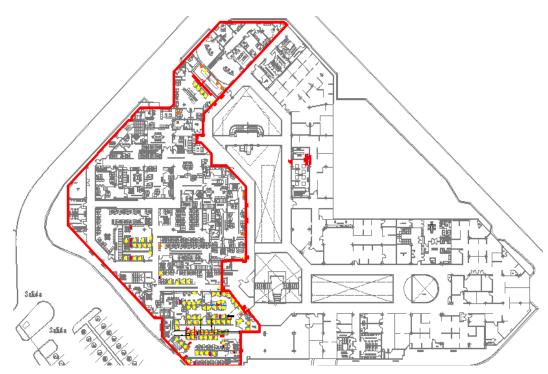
Plano Arquitectónico de Planta Alta reestructurada del Centro Integral de Seguridad (CIS).
